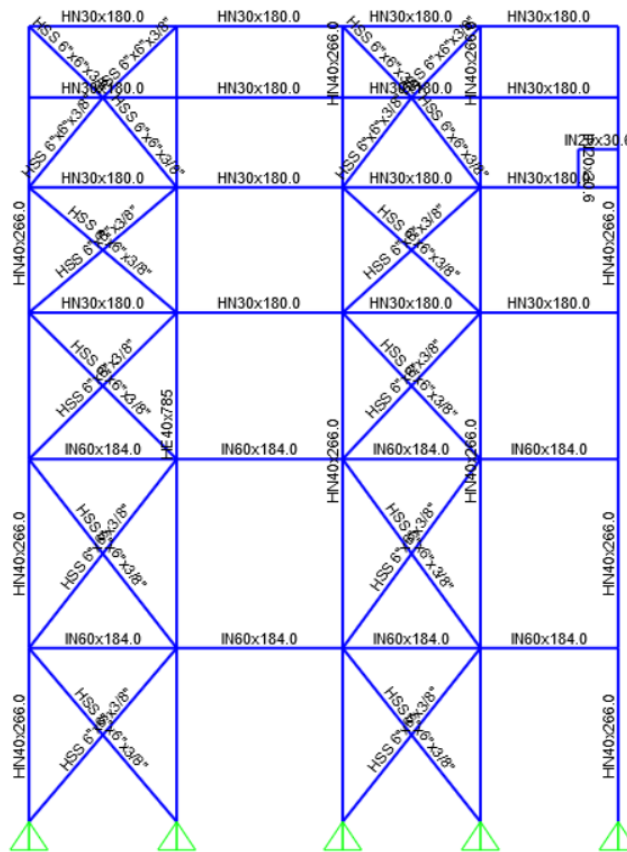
Secciones de perfiles-Elevación Eje Y=0m.
